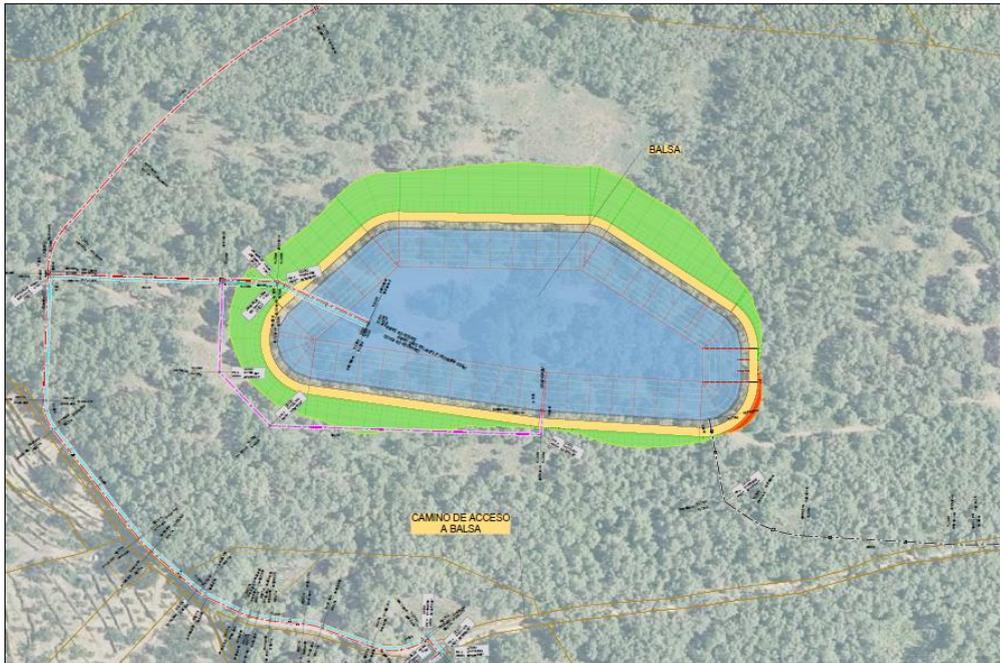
Planta de la balsa proyectada en el Sector Infierno
